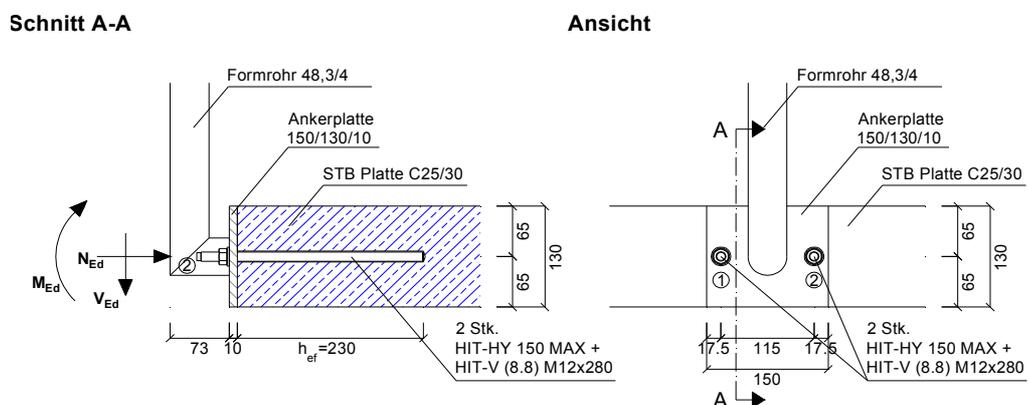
Anschlussdetail G1 Dübel Variante 2 (Maße in mm)
